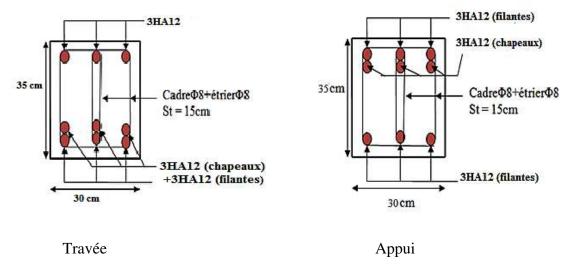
Schéma de ferraillage des poutres secondaires des Etages* 8 – 9.
